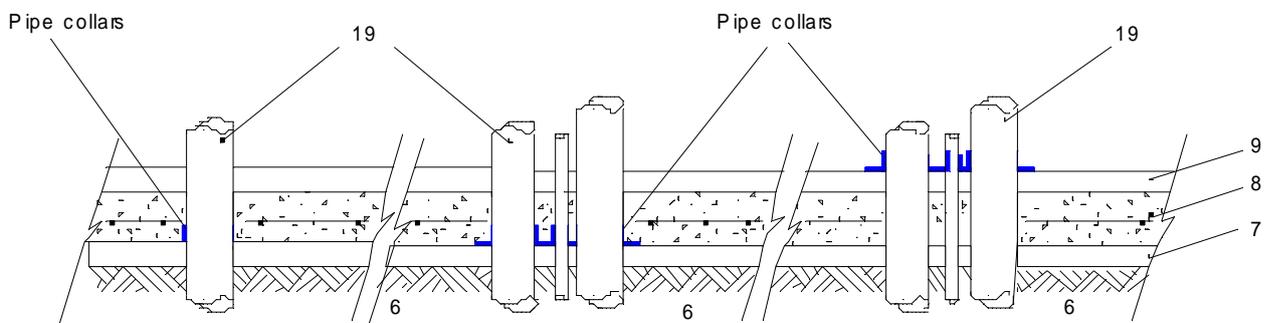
TRITHOR™ Pipe Collars avant et après coulage
